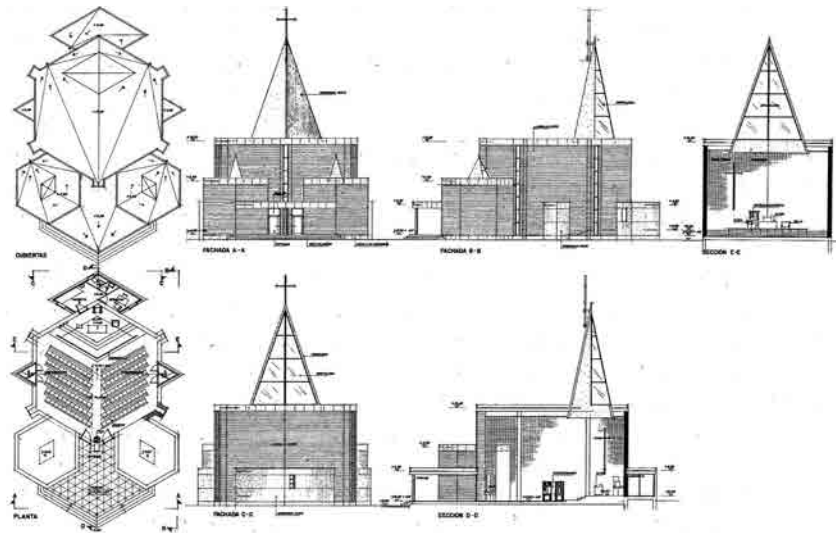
, Fig. 51, Fig. 52, Fig. 53, Fig. 54, Fig. 55 y Fig. 56 Capilla. Fila superior, de izquierda a derecha: planta de cubiertas, alzado principal, alzado lateral y sección transversal. Fila inferior, de izquierda a derecha: planta, alzado posterior y sección longitudinal.
